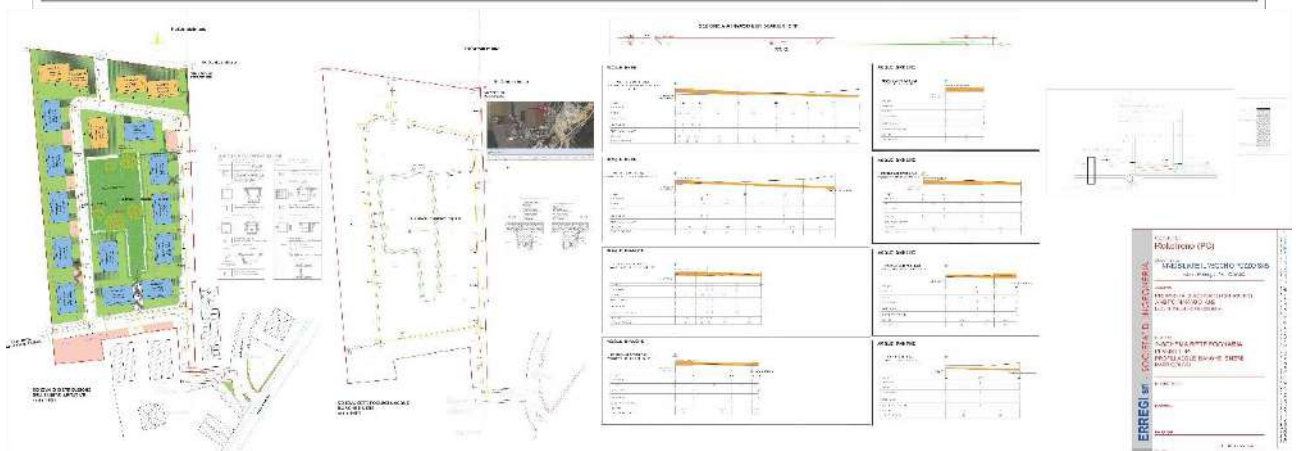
Planimetria di progetto, piante e prospetti e planimetria con schema della rete fognaria (Progettazione, Dott. Arch. Paolo Pagani)
